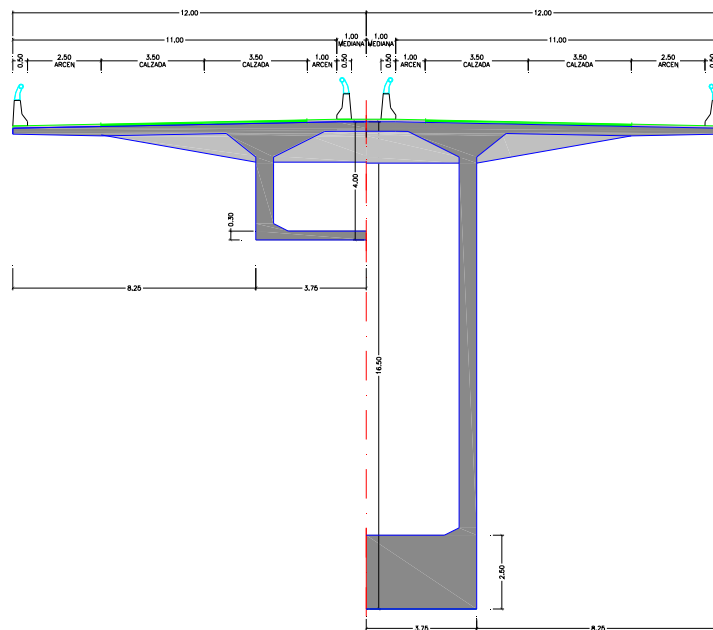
Solución propuesta. Sección transversal por centro de vano y apoyos
